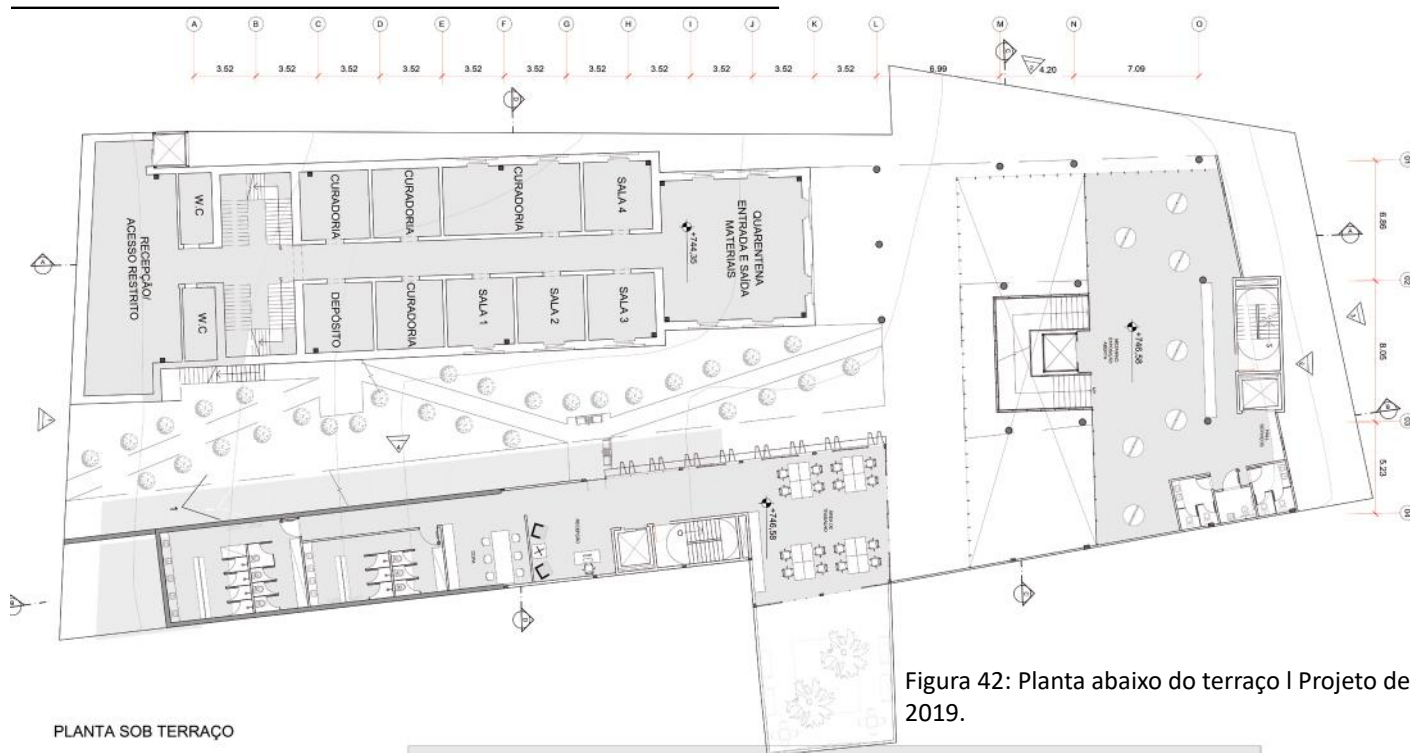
Planta abaixo do terraço | Projeto de Laís Paraizo, 2019.
